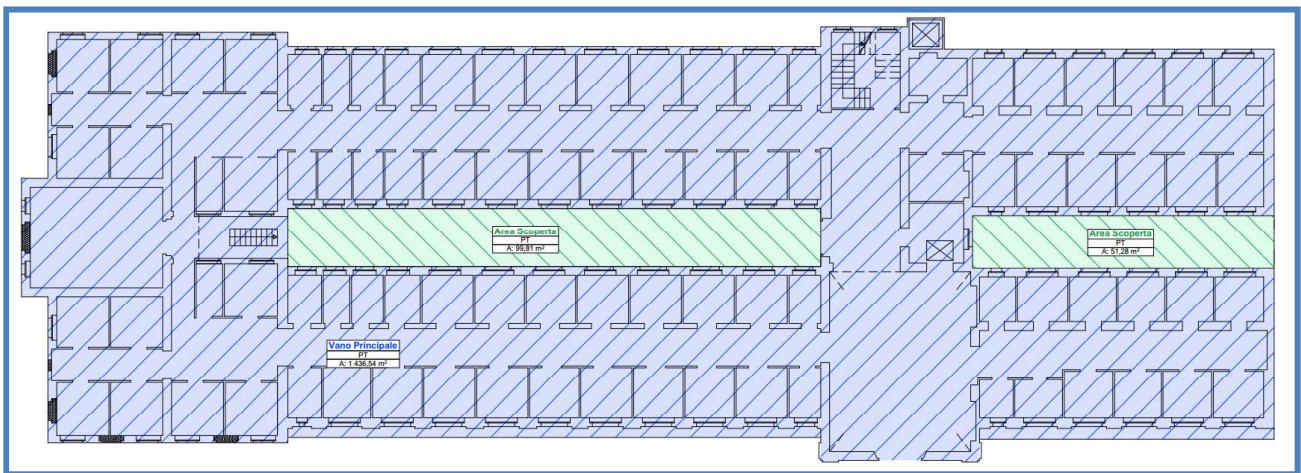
fabbricato ex prima fanghi - PIANTA PIANO TERRA
